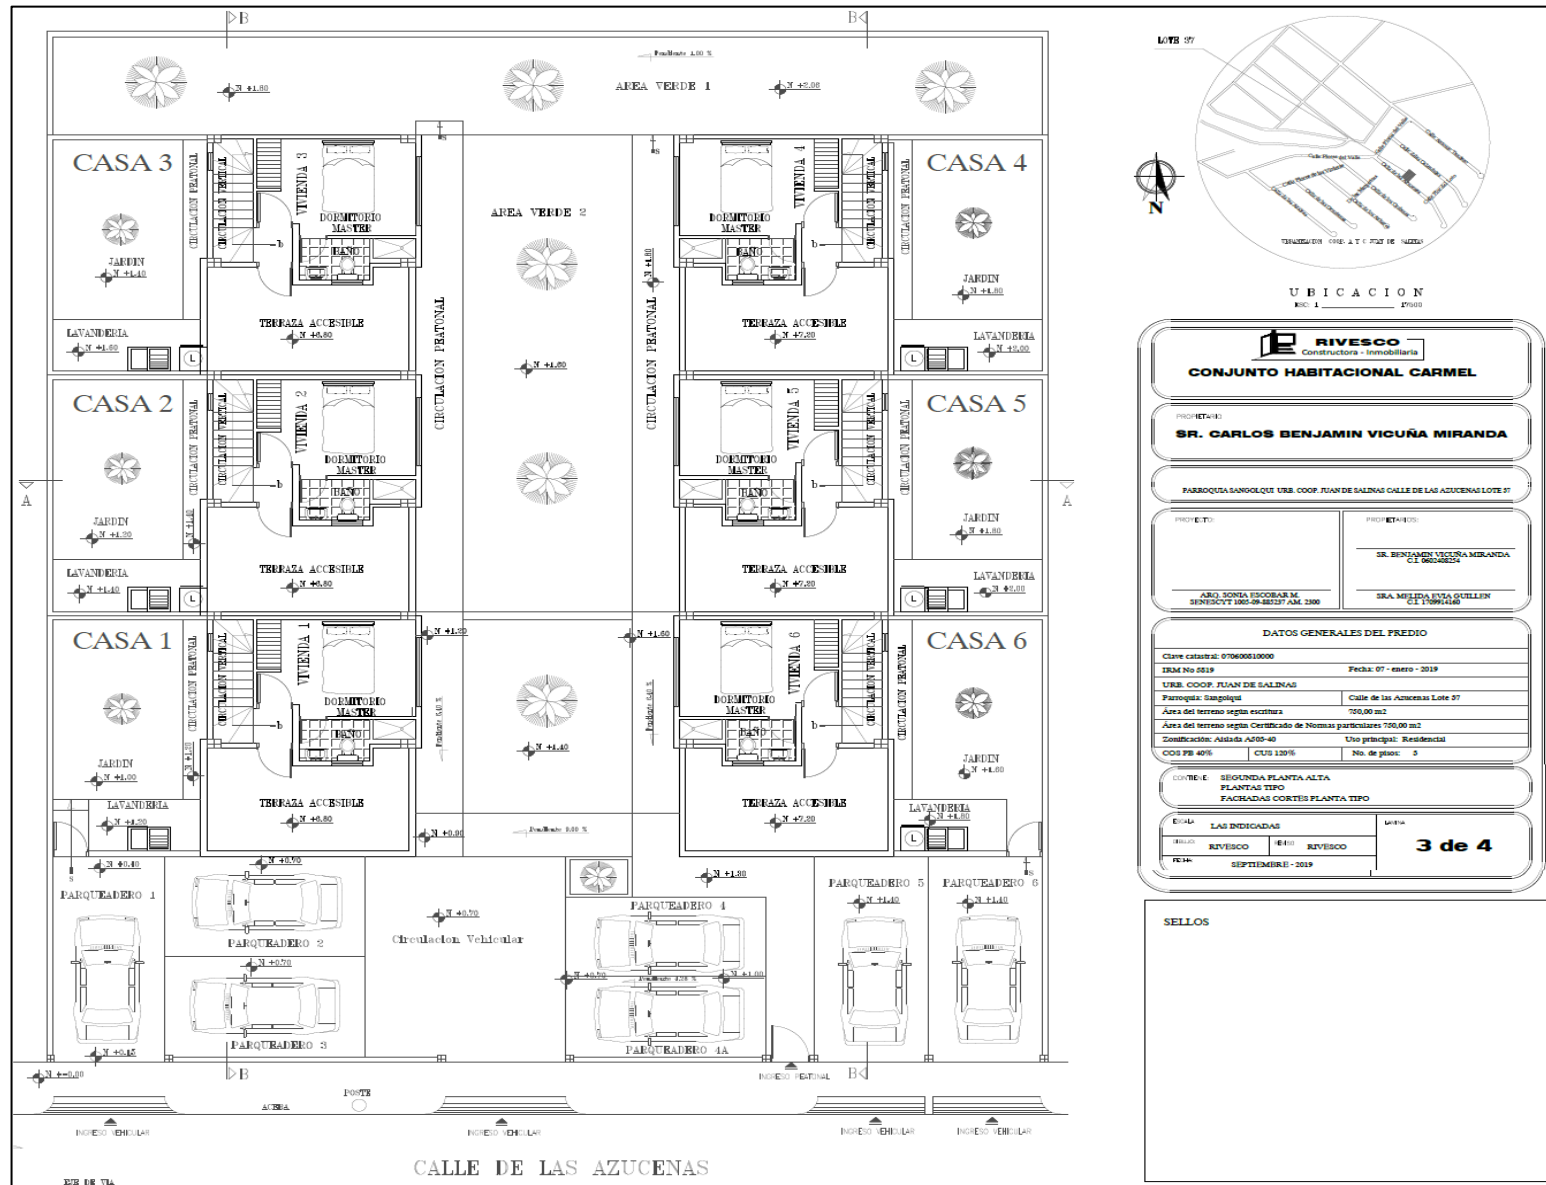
13: Planos Arquitectónicos – Distribución de Viviendas
